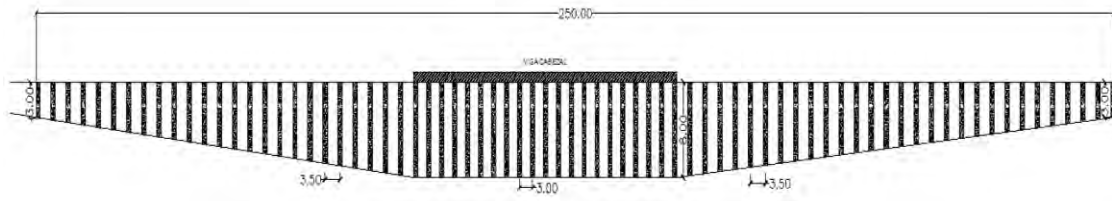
Esquema de procedimiento constructivo de by-pass mediante muros de pilotes. (Fuente: Sulzer)
